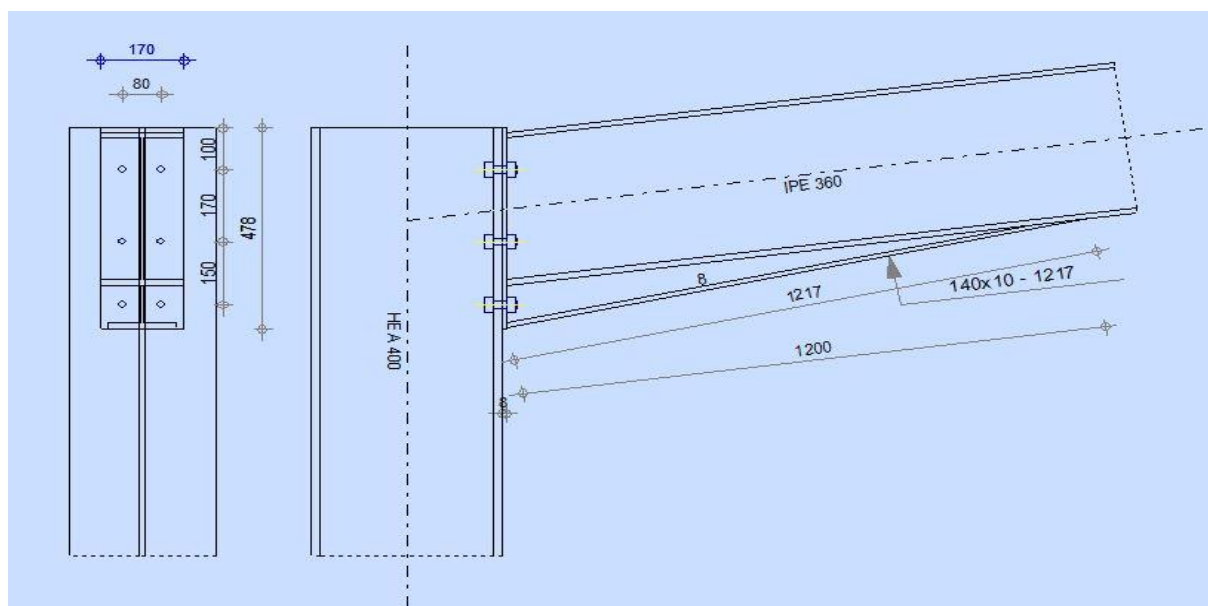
Détail sur l'assemblage poteau traverse IPE360.
